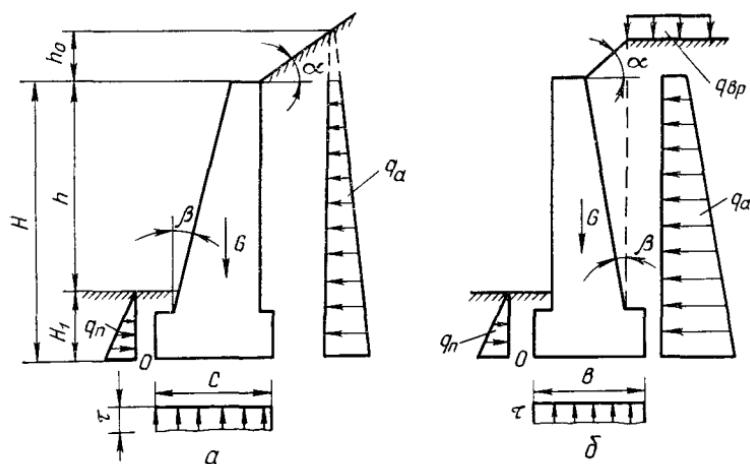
Схемы нагрузок для расчета подпорных стенок:
